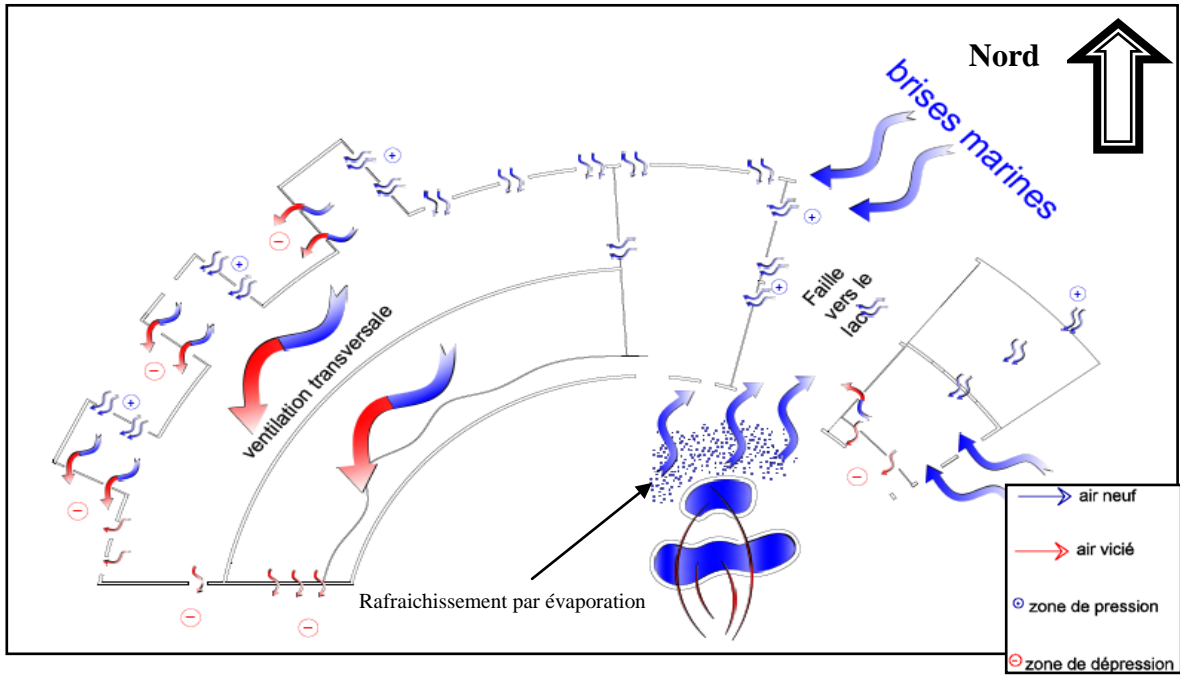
principe de ventilation transversale et le rafraichissement par évaporation sur plan (entité loisir)
